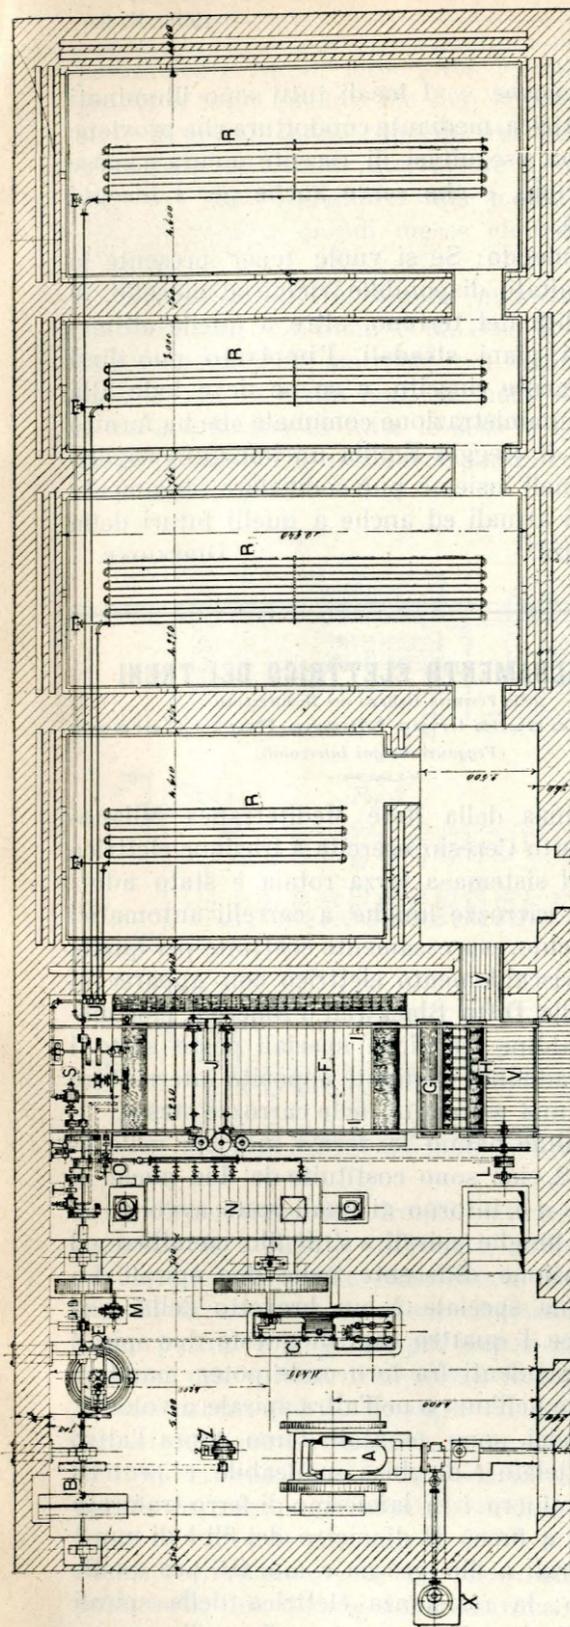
Pianta del piano terreno (Scala 1:160).
